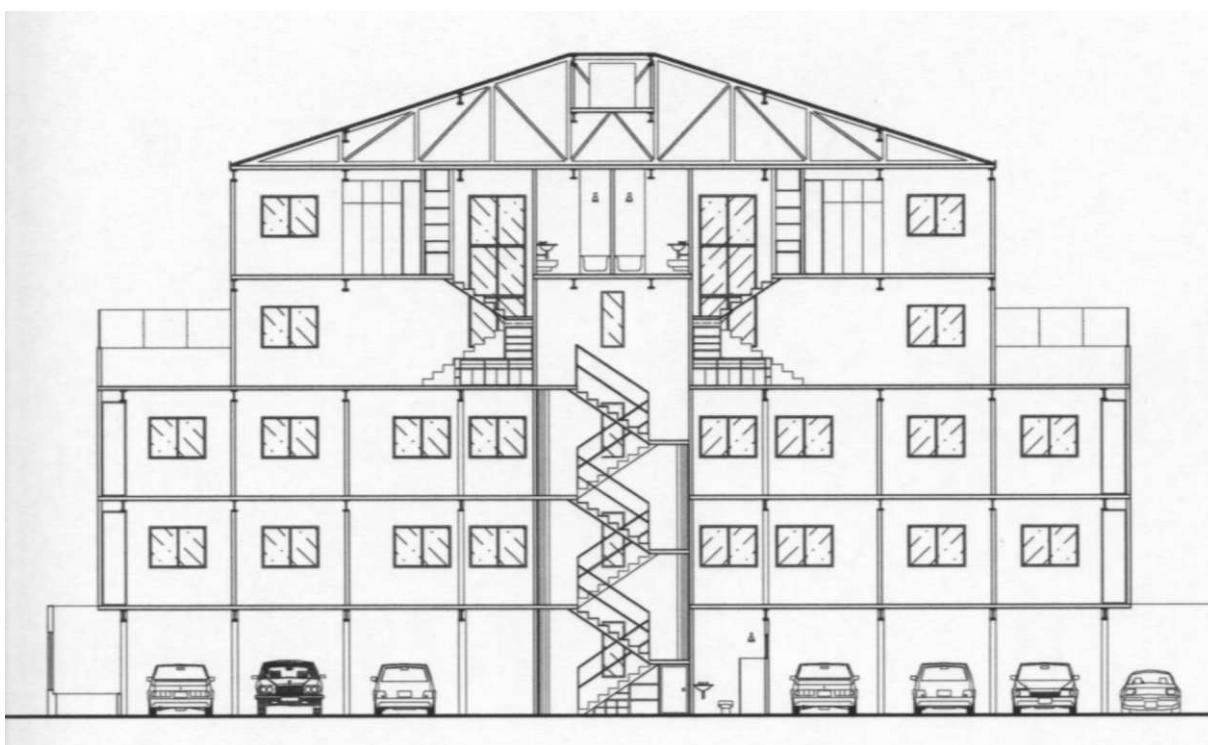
Corte longitudinal apresentando estrutura e engradamento de telhado.
